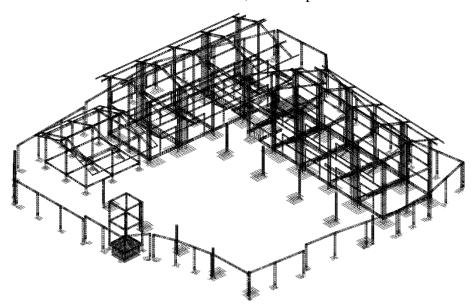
Categoría Armadura Estructural aislada del modelo federado de Estructuras
